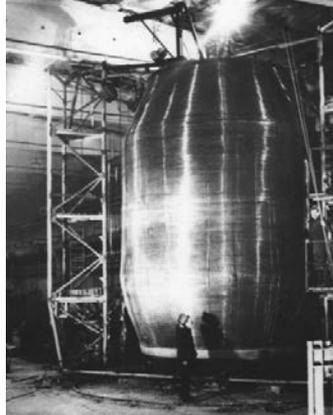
Общий вид крупномасштабной модели ЯР после намотки последнего слоя арматуры перед бетонированием
